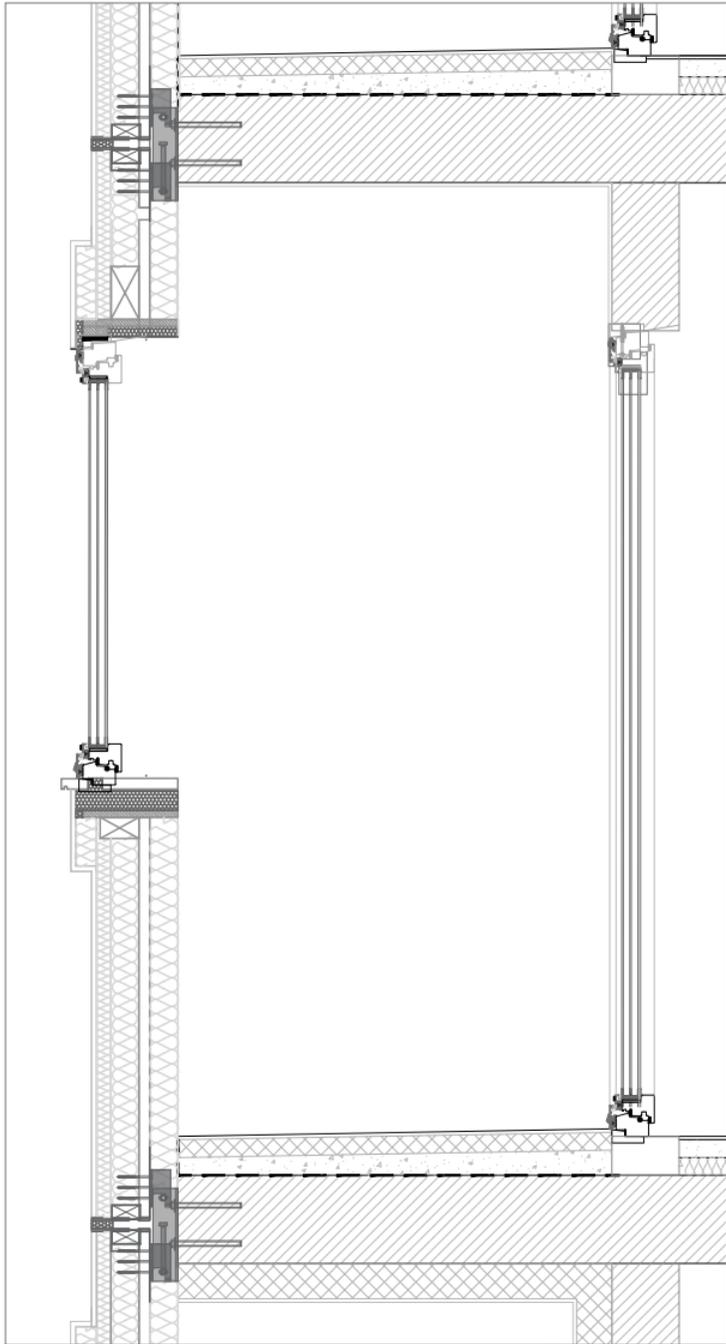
Nodo modulo con balcone chiuso, sezione e pianta scala 1:20
